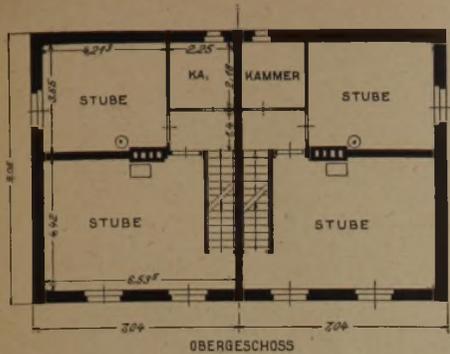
u. 7. Grundrisse eines Zweifamilien-Reihenhauses. (1 : 250.)
